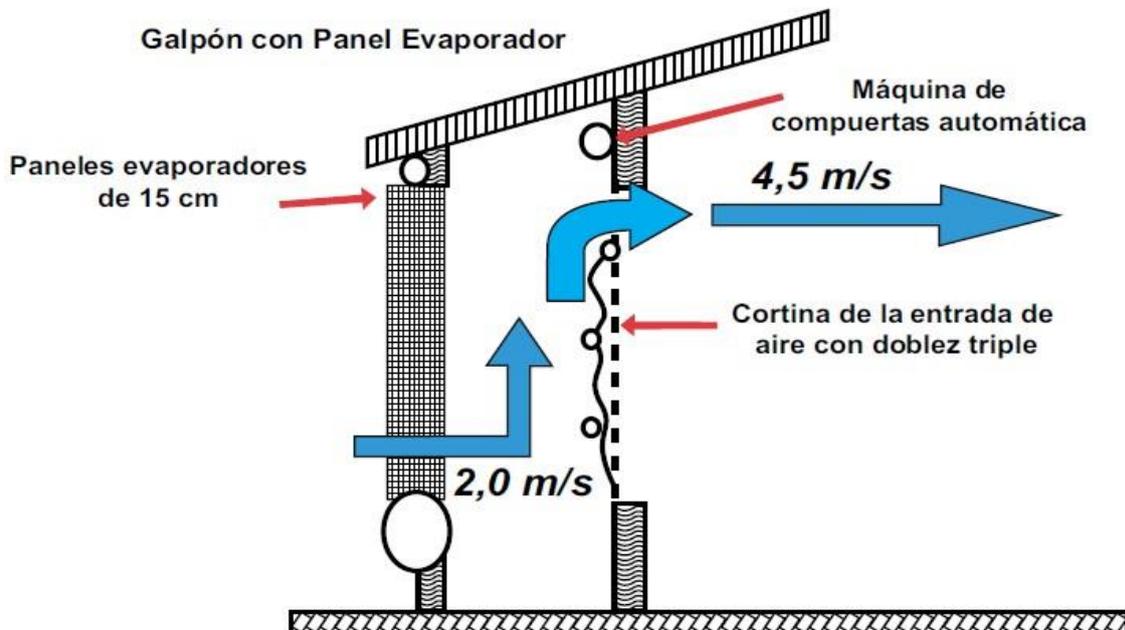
Diseño del panel evaporador. (Cobb 2012)
